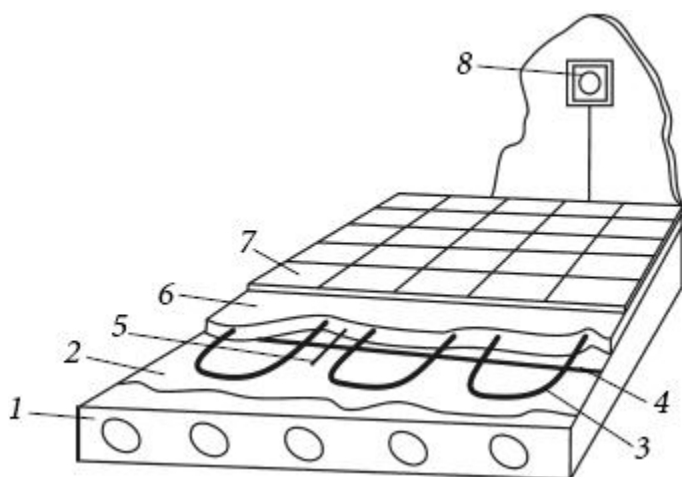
Система «теплый пол» под другими напольными покрытиями: 1) плита перекрытия; 2) слой теплоизоляции; 3) нагревательный кабель; 4) монтажная лента; 5) датчик температуры; 6) цементно-песчаная стяжка; 7) напольное покрытие; 8) термостат
